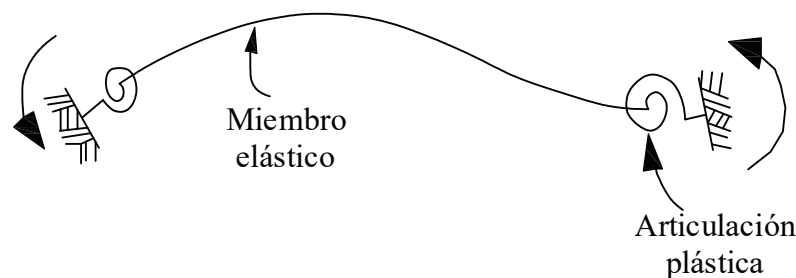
Configuración de articulaciones plásticas para elementos tipo Viga-Columna
